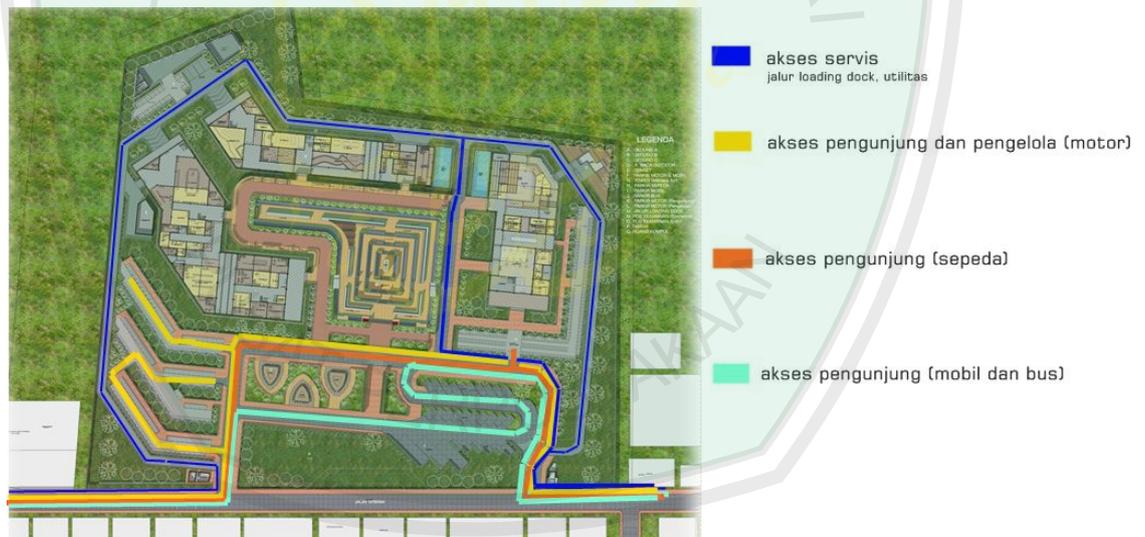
Layout dan Site Plan Kawasan Perpustakaan Outdoor
